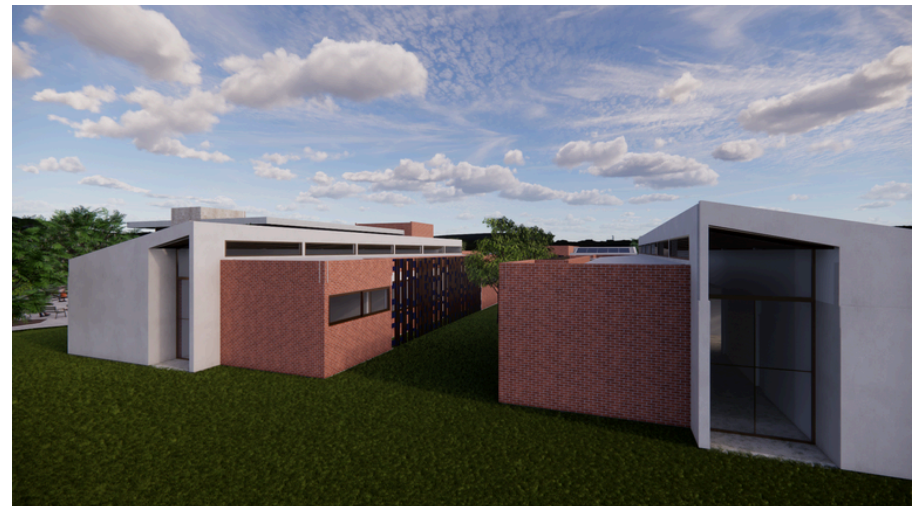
Fachada nordeste com destaque para o painel metálico vazado e para as venezianas entre as coberturas. Elaborado pela autora.
